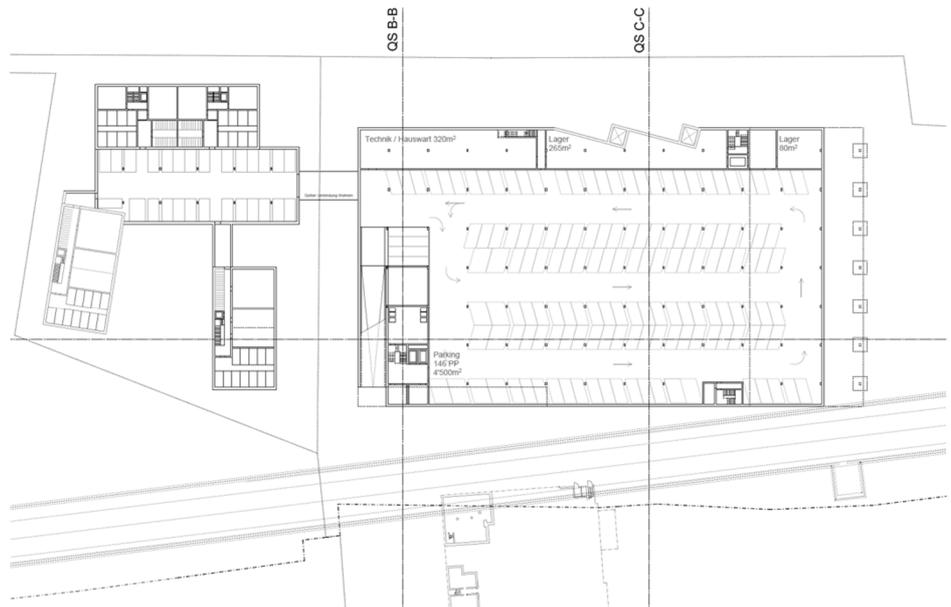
Verlauf der Tunnelröhre (unterer Bildrand)
